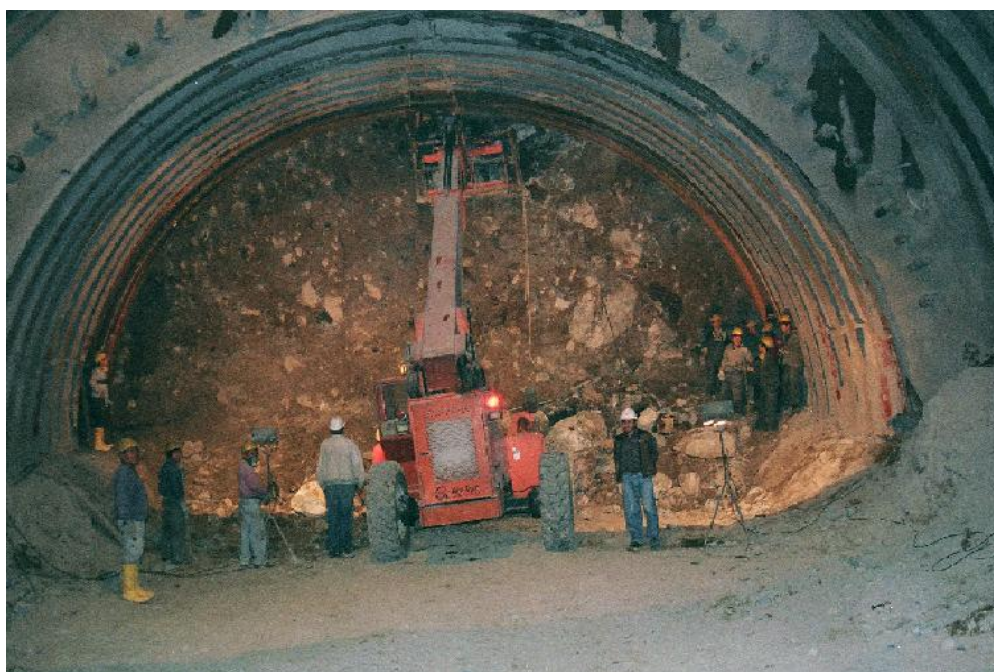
Sostenimiento de hormigón lanzado, armado con malla y marcos rígidos. (PROAÑO, 2009)¹⁸⁹
